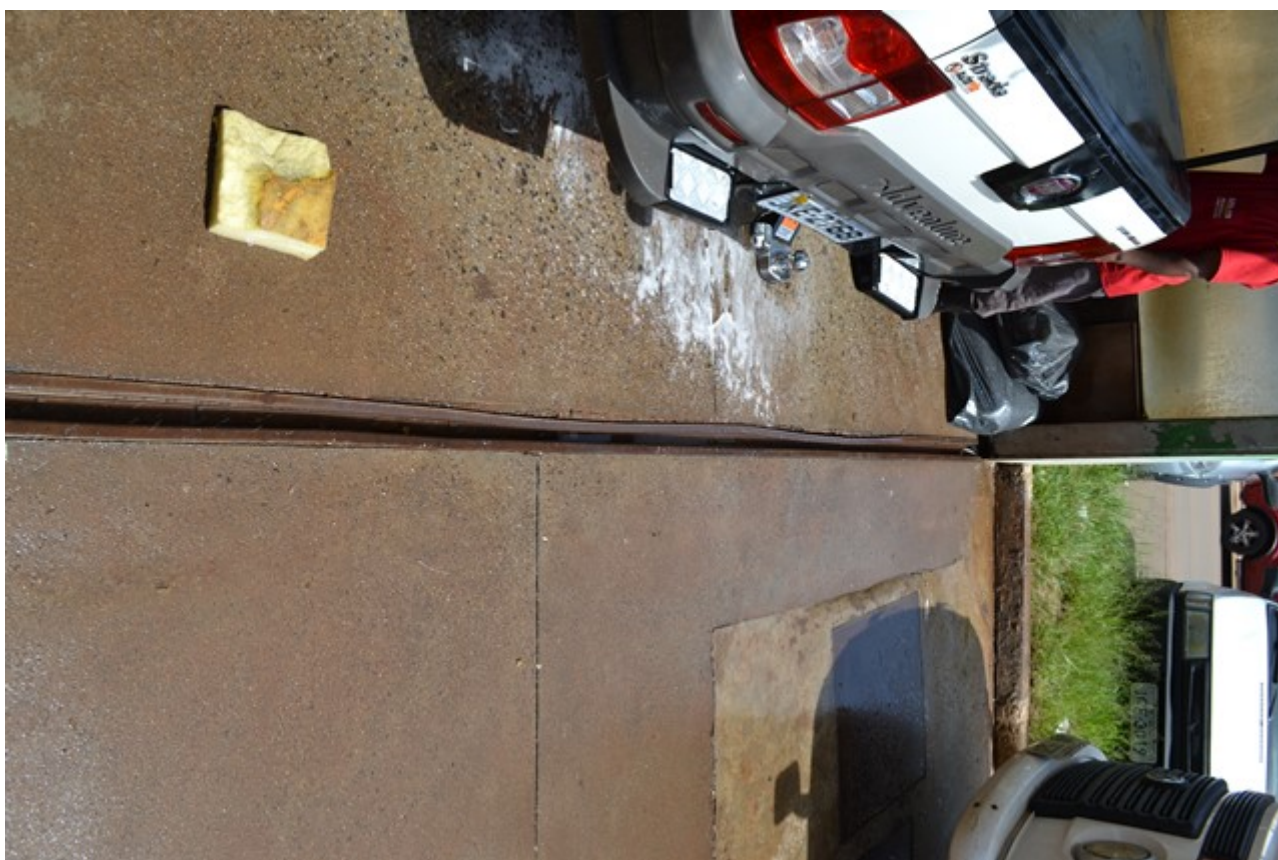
Entrada do lava-jato com canaletas contemplando toda área.
